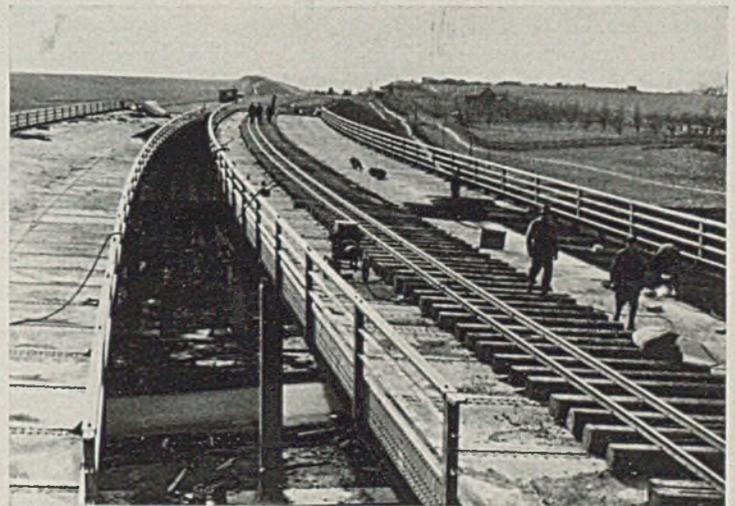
Sicht auf die fertig genietete Fahrbahn — rechts Aufschweißen des Streckmetalls.
